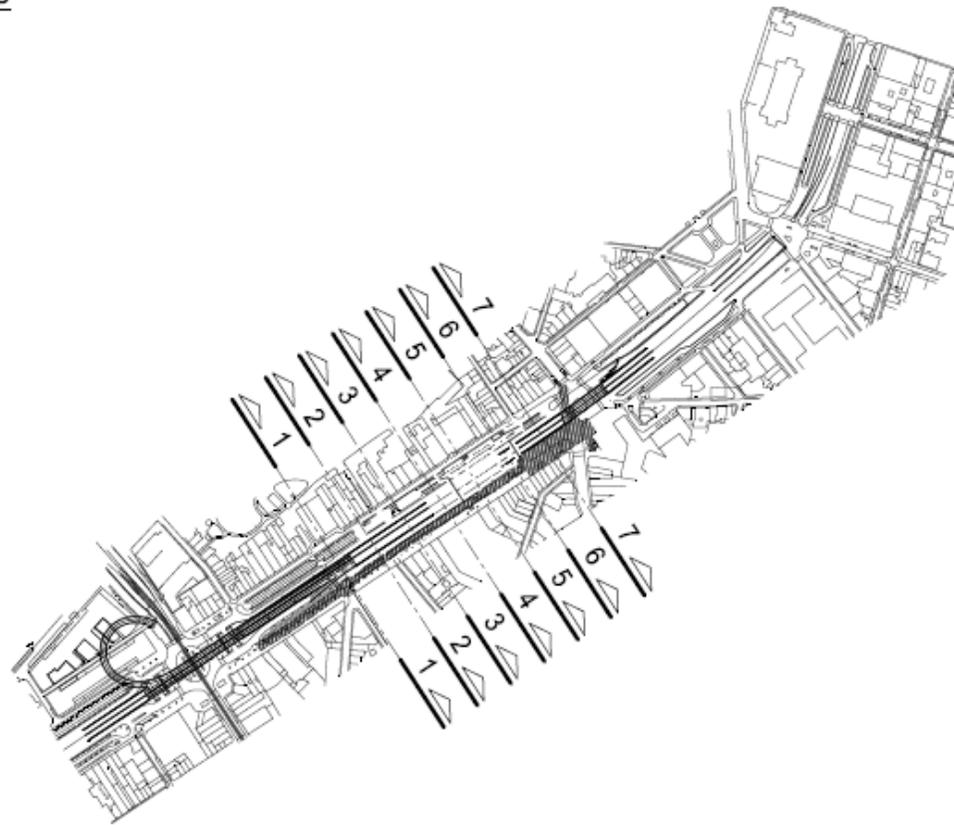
Topographie de la zone de projet dans la situation existante à hauteur de la Chaussée de Waterloo (Source : Geopunt Vlaanderen).
